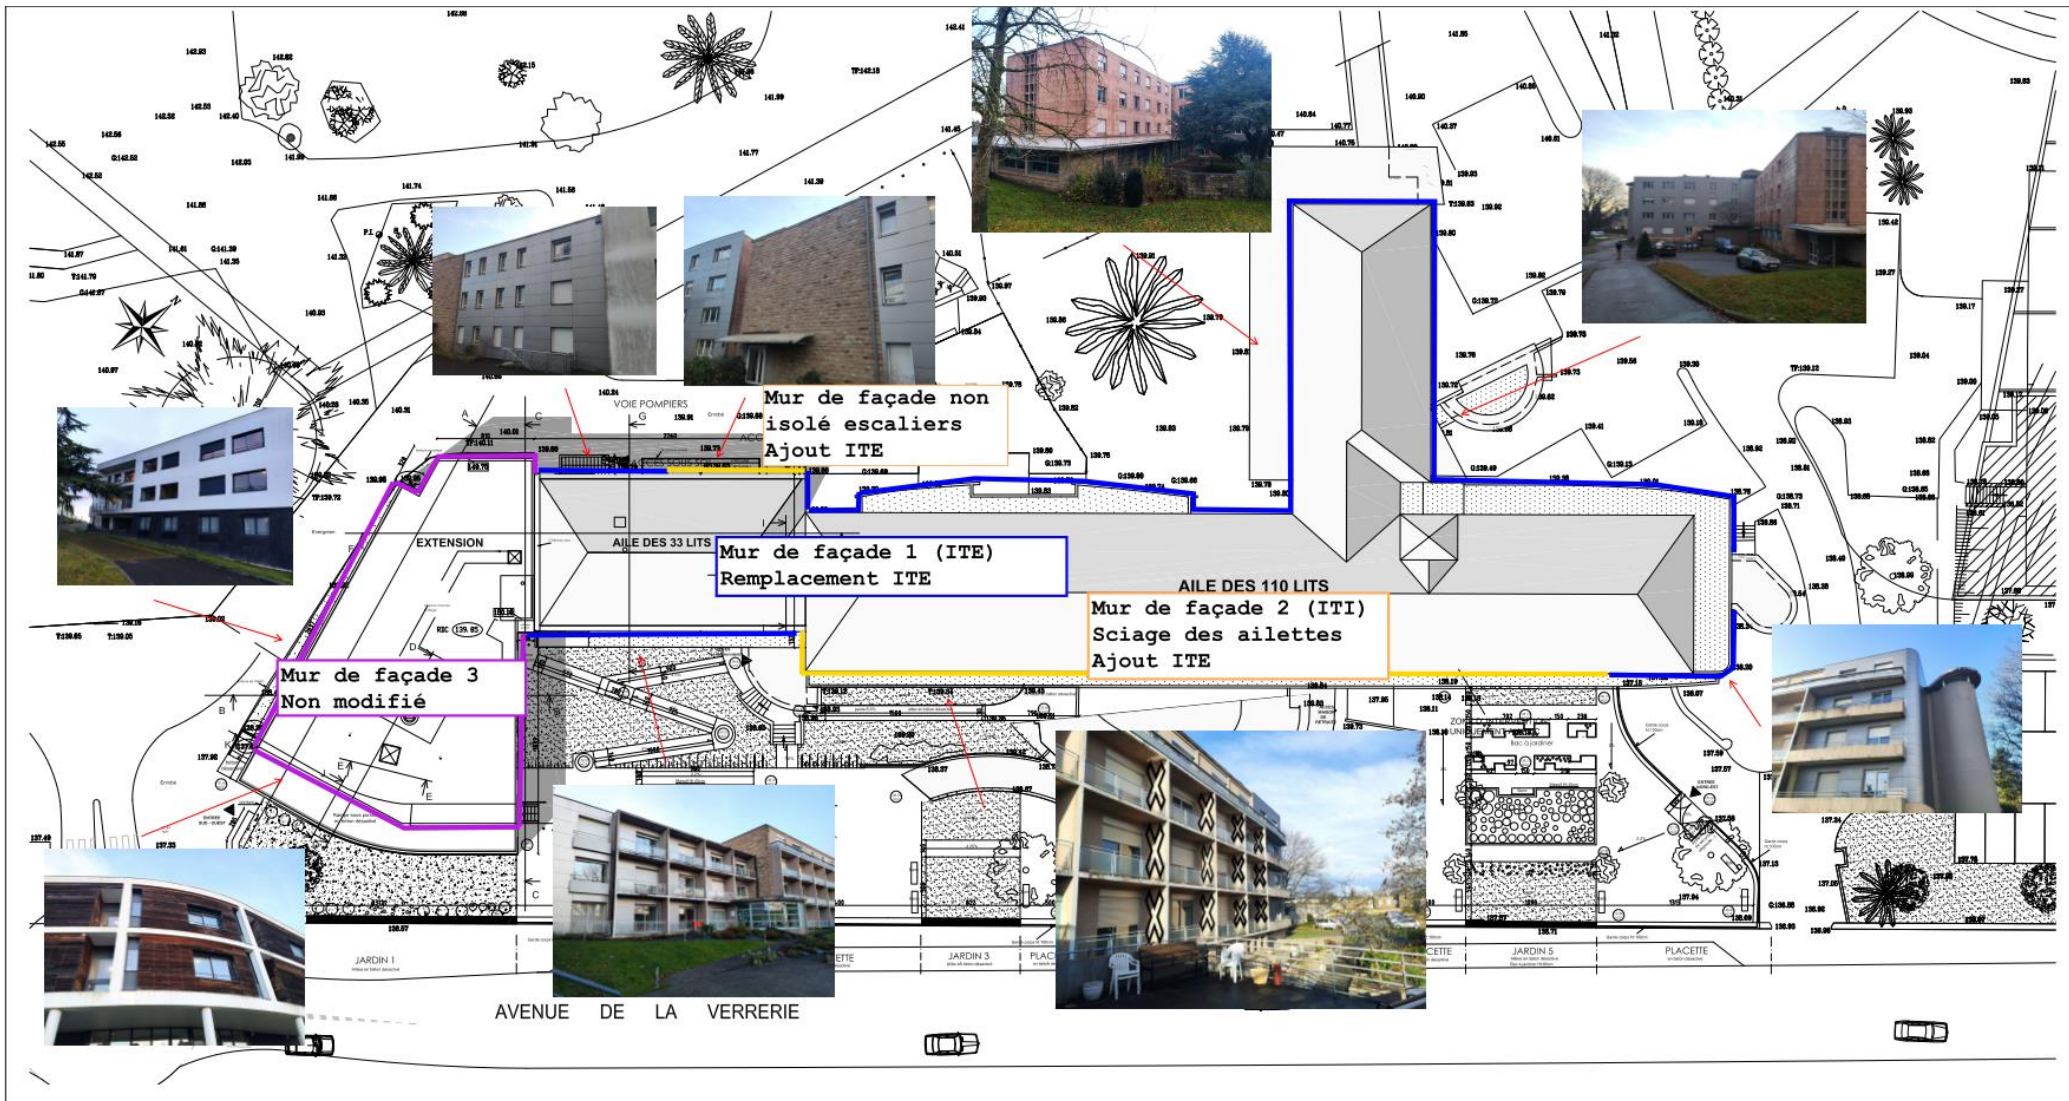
Plan de repérage des travaux d'isolation par l'extérieur sur Bel Air
